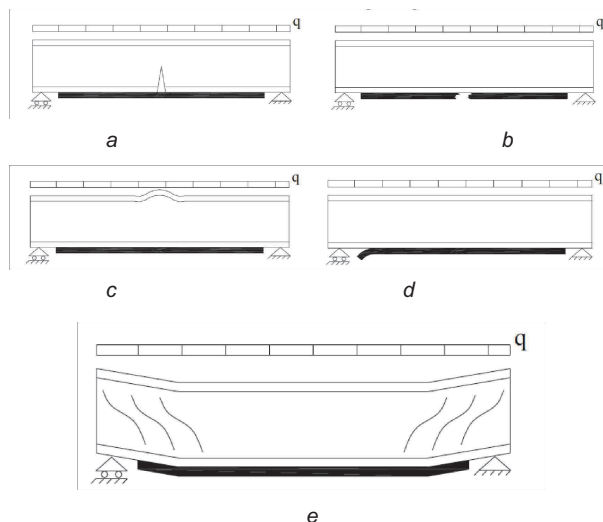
Схемы разрушения изгибаемой металлической балки, усиленной ФАП: а) разрушение от растяжения в усиливаемой балке; б) разрушение от растяжения ФАП; в) местное выпучивание усиливаемой балки; д) отслоение ФАП; е) разрушение от сдвига
